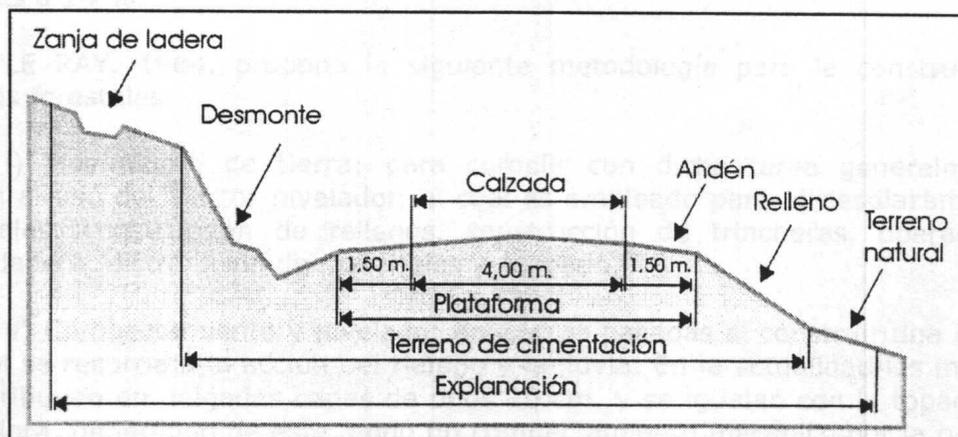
Corte transversal de una carretera forestal (modificado de LE RAY, 1964)
